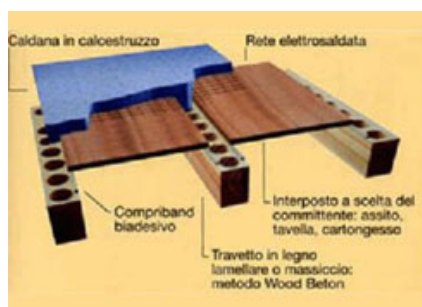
Schema del sistema costruttivo Wood Beton.
